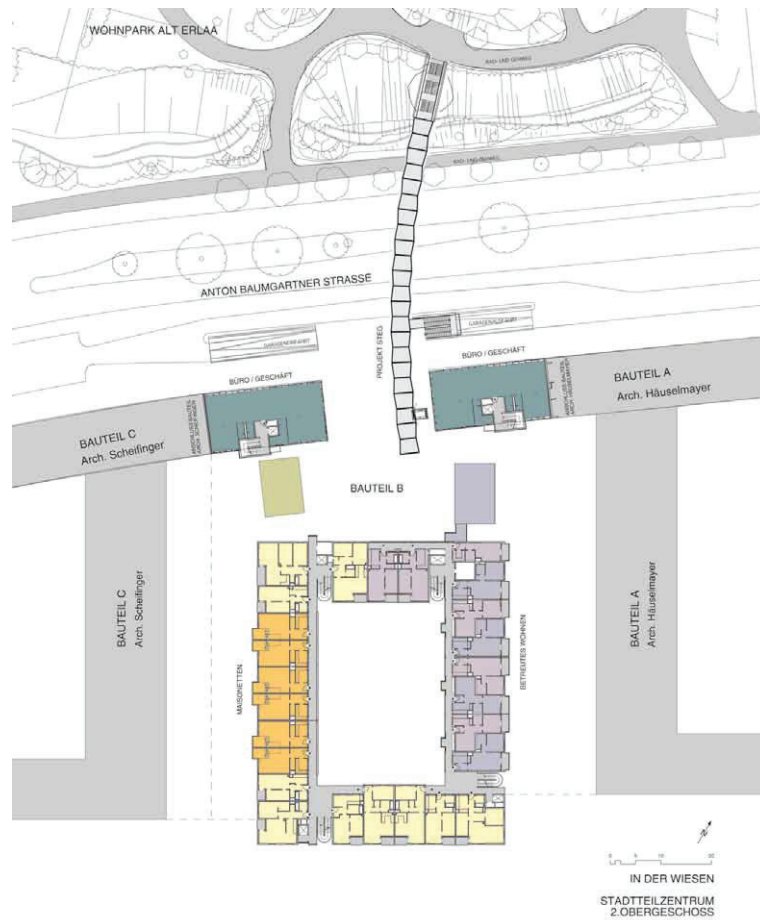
/ Plano plantas 3-5, viviendas para ancianos en violeta.
